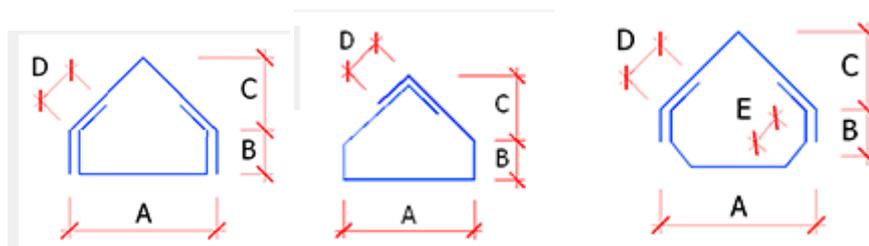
Tipos de armaduras en el ala inferior.
